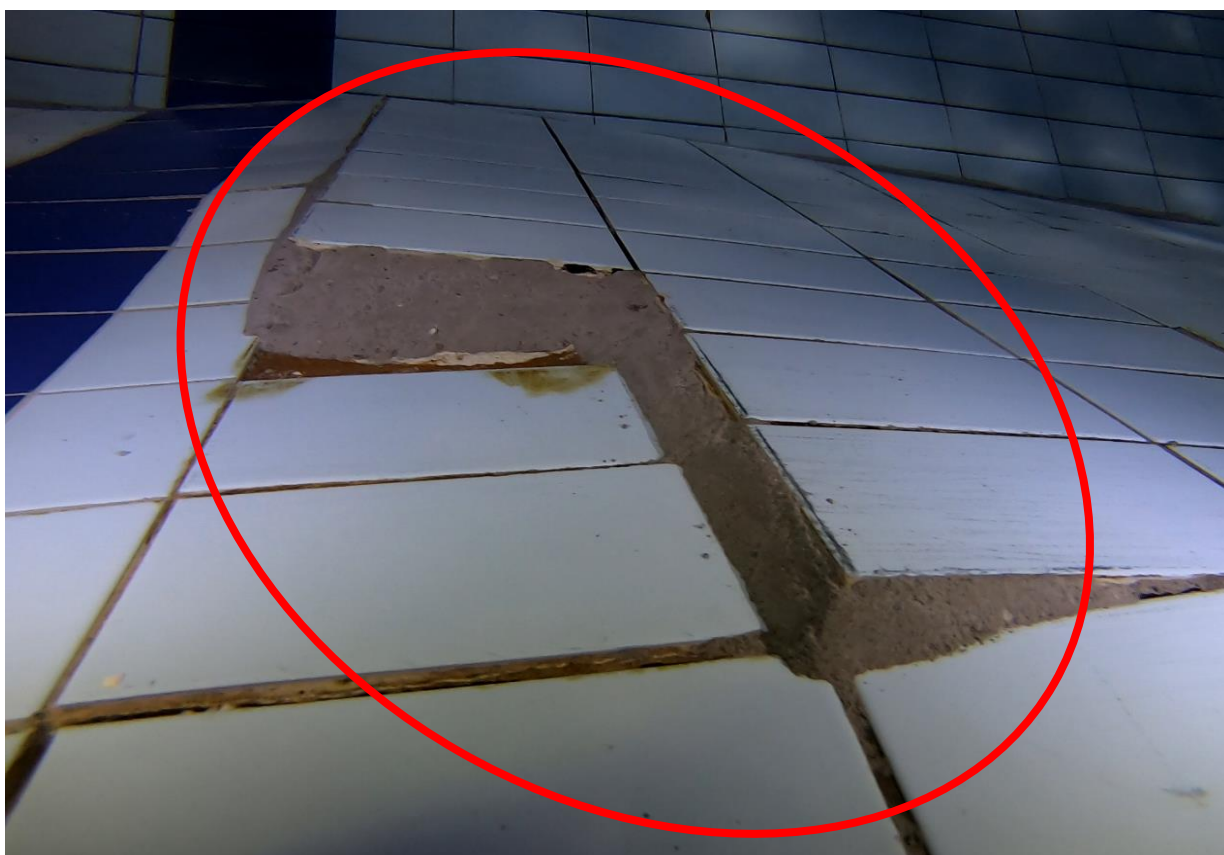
Detailní pohled na poškození dna plaveckého 50m bazénu a vznik dutin.
